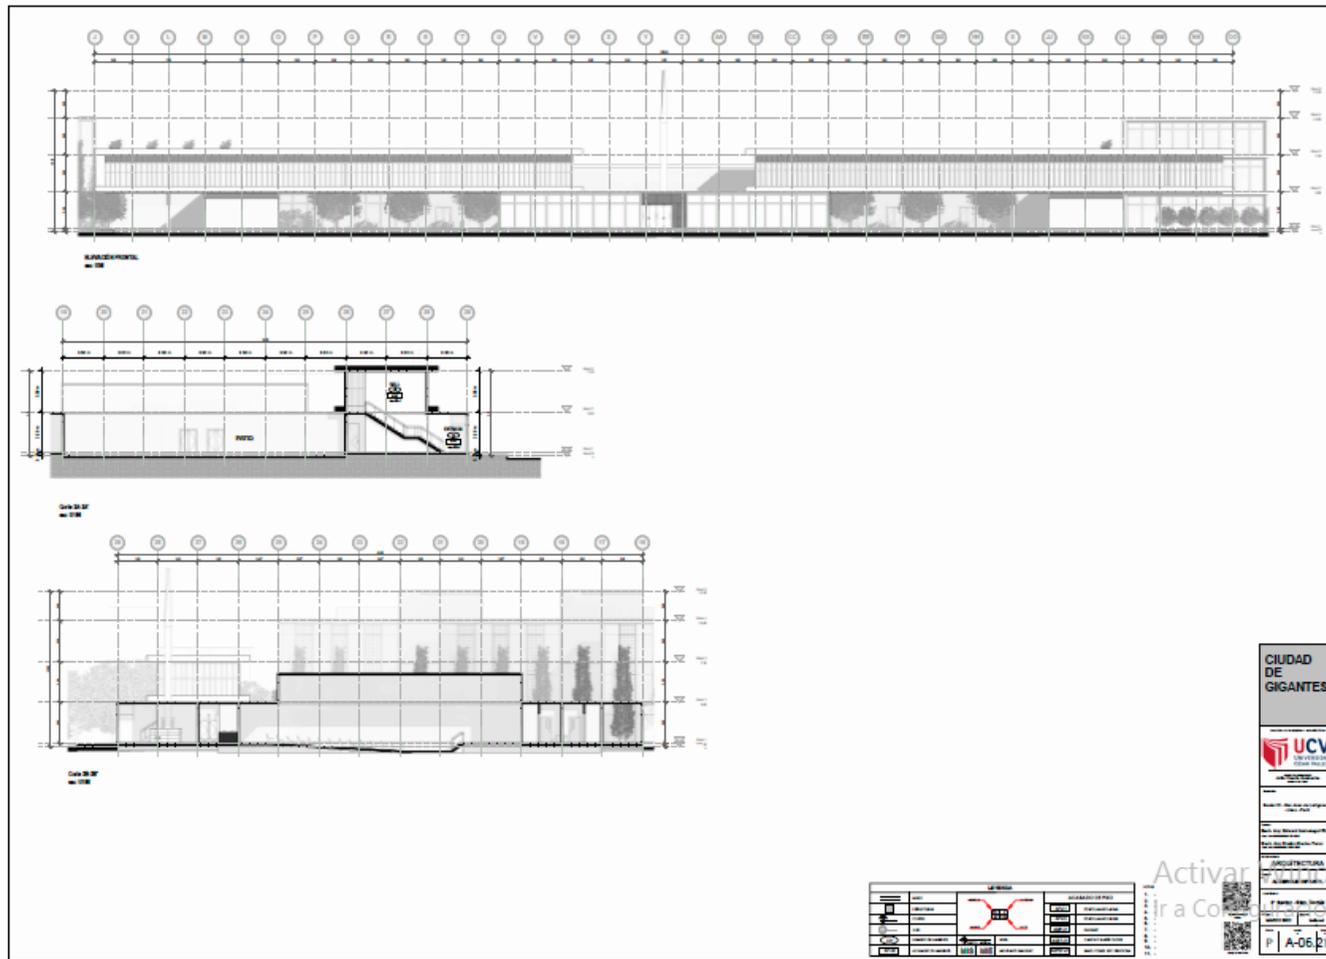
Plano de Corte y Elevación Sector Servicios Complementario
